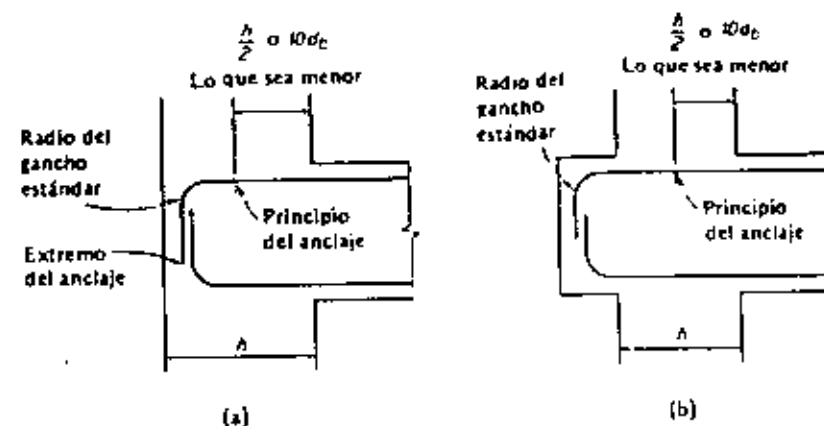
Anclaje de las varillas de la viga en una columna exterior, cuando es factible que se forme la articulación plástica en la viga en el paño de la columna. a) Anclaje en las columnas, b) anclaje en el talón de la viga.
